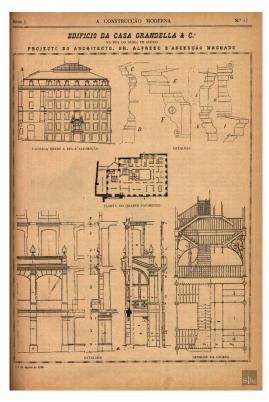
Capa da revista *A Construcção Moderna*, N.º13, agosto de 1900. Disponível em: http://ric.slhi.pt/A_Construcao_Moderna/revista
